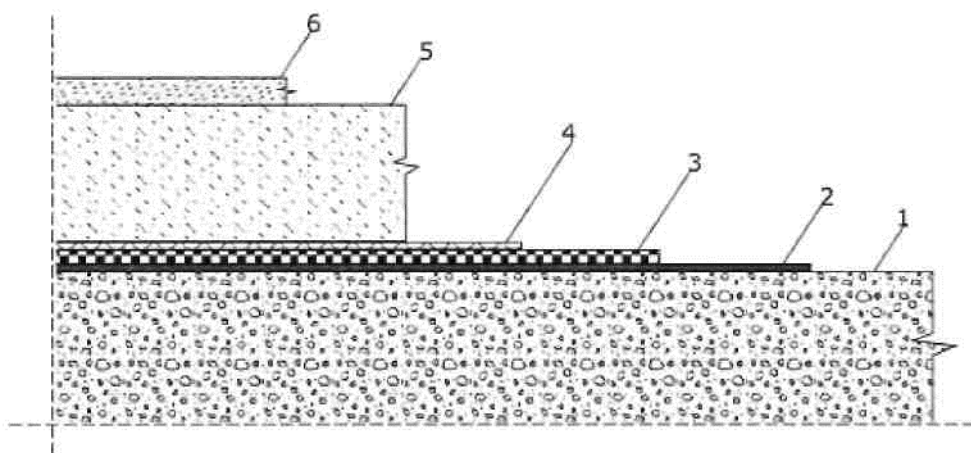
Гидроизоляция термоусадочного шва между конструкциями
